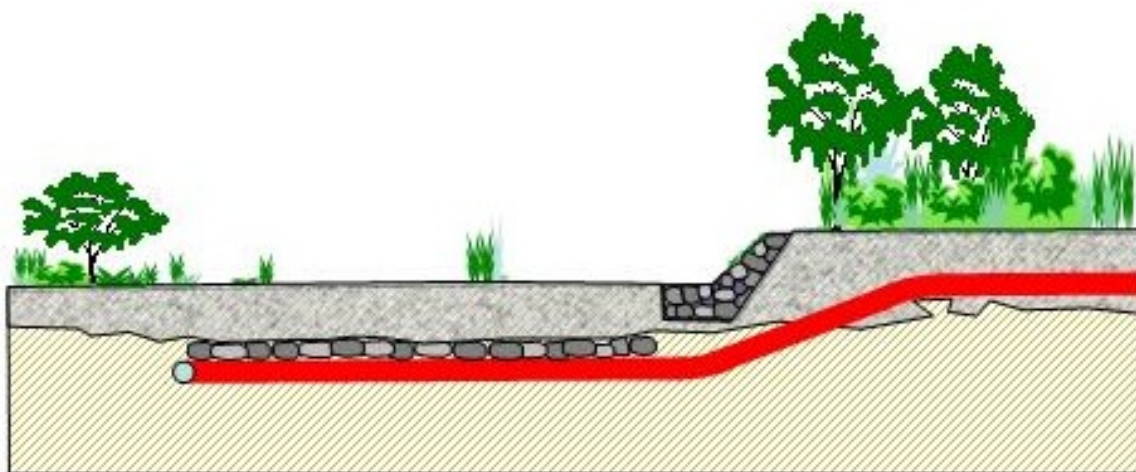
/A: Sezione schematica dell'attraversamento del T. Fanante
